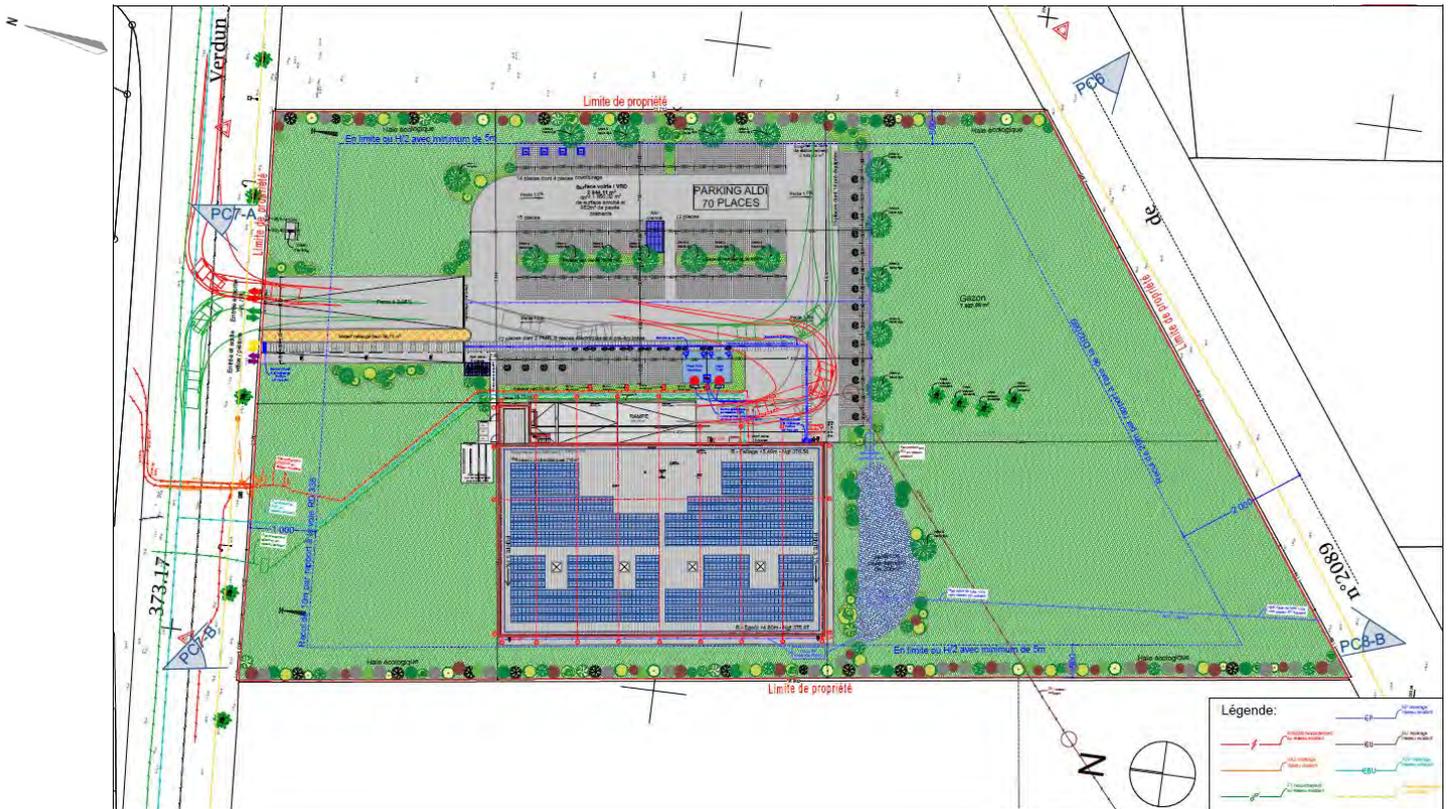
Plan masse du projet (Source : Immaldi & Cie – sans échelle)
